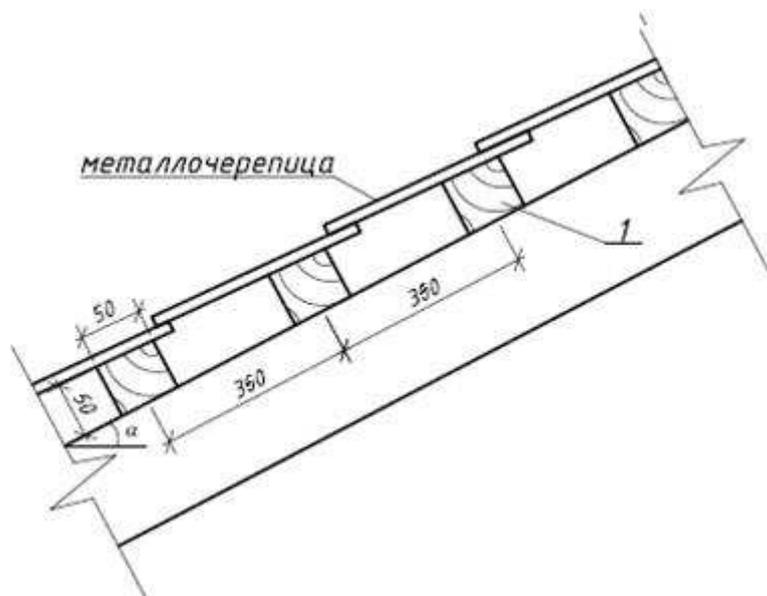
Крепление обрешетки к стропильной ноге
